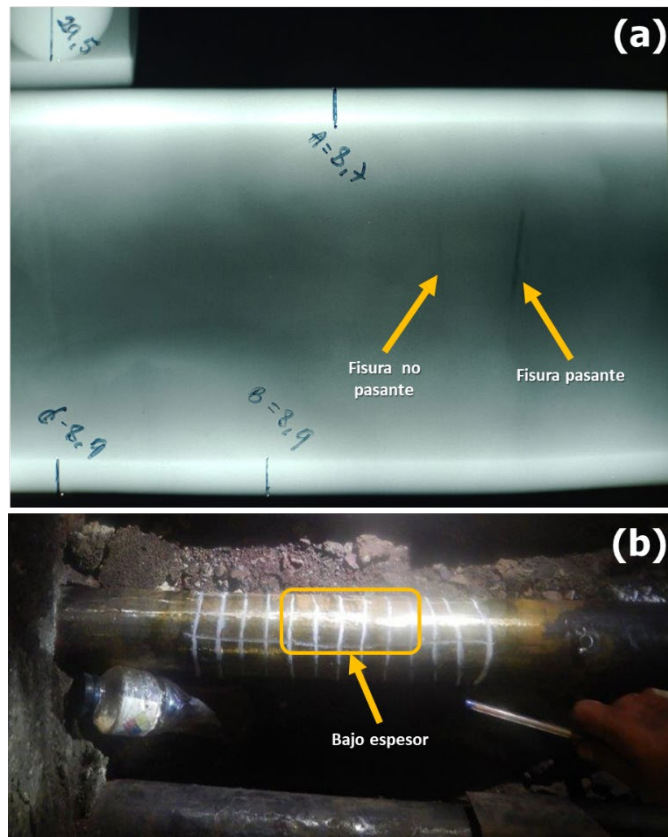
(a) Gammagrafía de perfil en zona de falla. Se identifica la fisura que da origen a la pinchadura junto con otra fisura no pasante ubicada en las cercanías de la primera. (b) Grilla empleada para la determinación del perfil de espesores en la zona de falla. Se detecta una zona de espesores mínimos de 2 mm.
